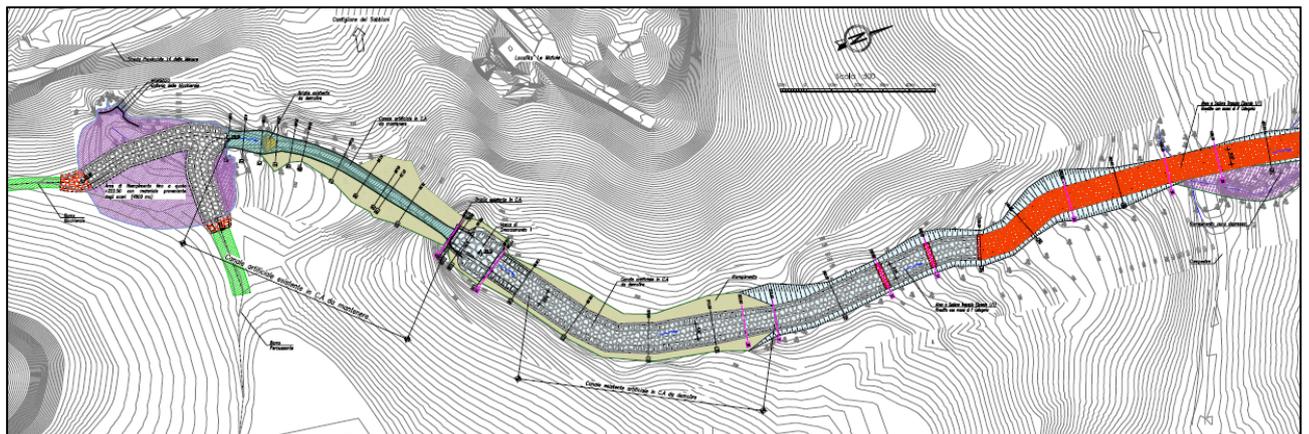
Planimetria Tavola 1/2 – Borro Percussente
